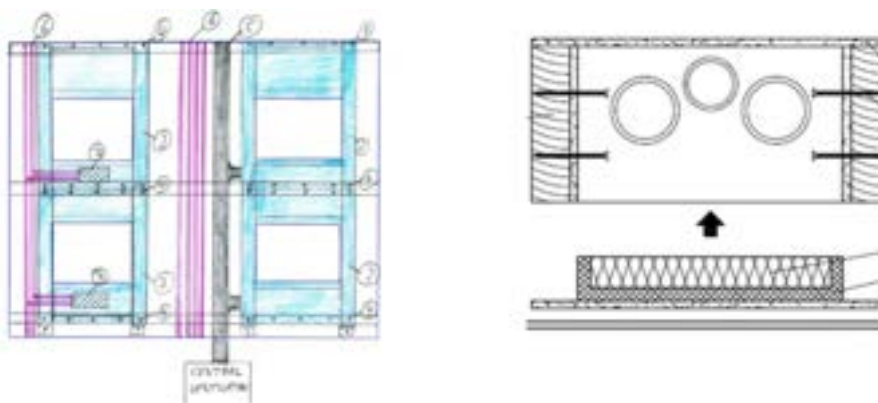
Progetto P2ENDURE – Sequenza di installazione di tubi e cavi e chiusura del vano di installazione
